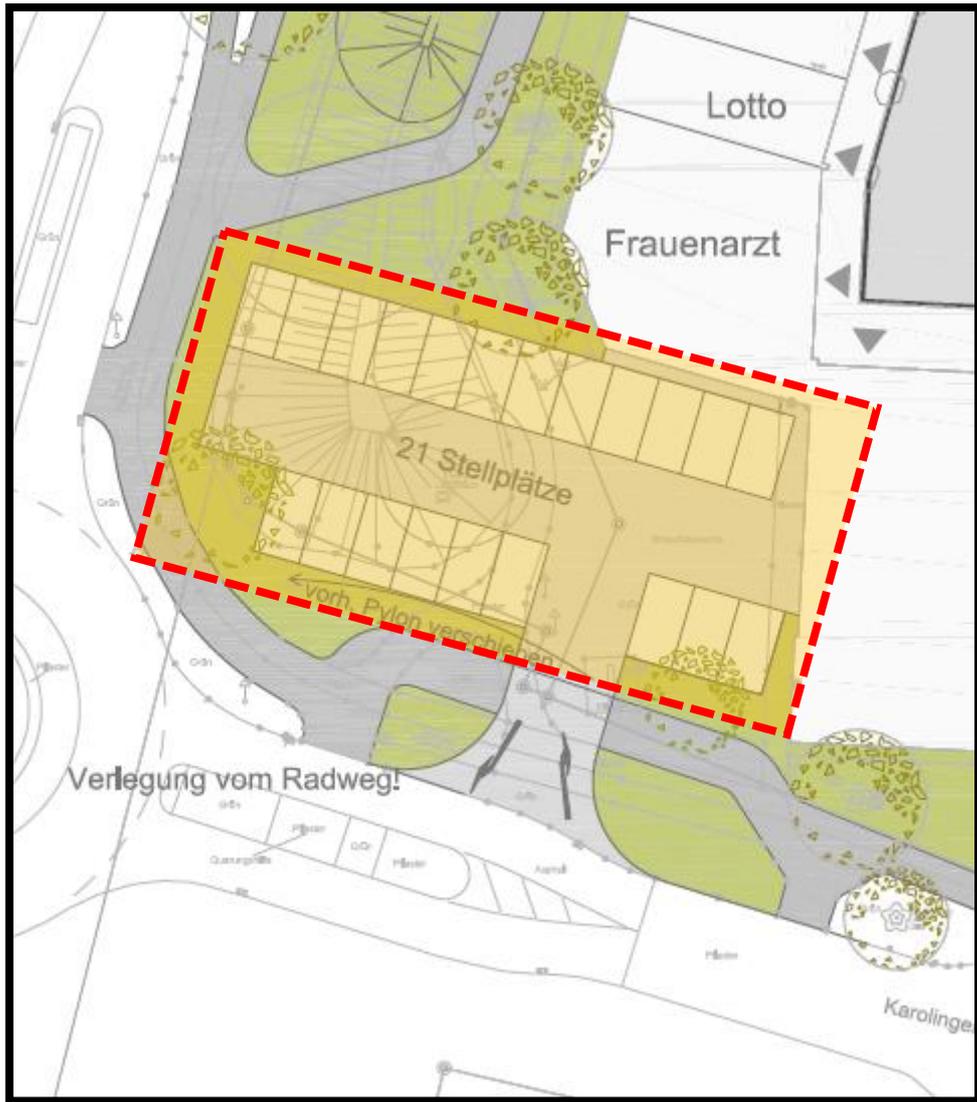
Parkplatzplanung im Südwesten des Plangeländes
